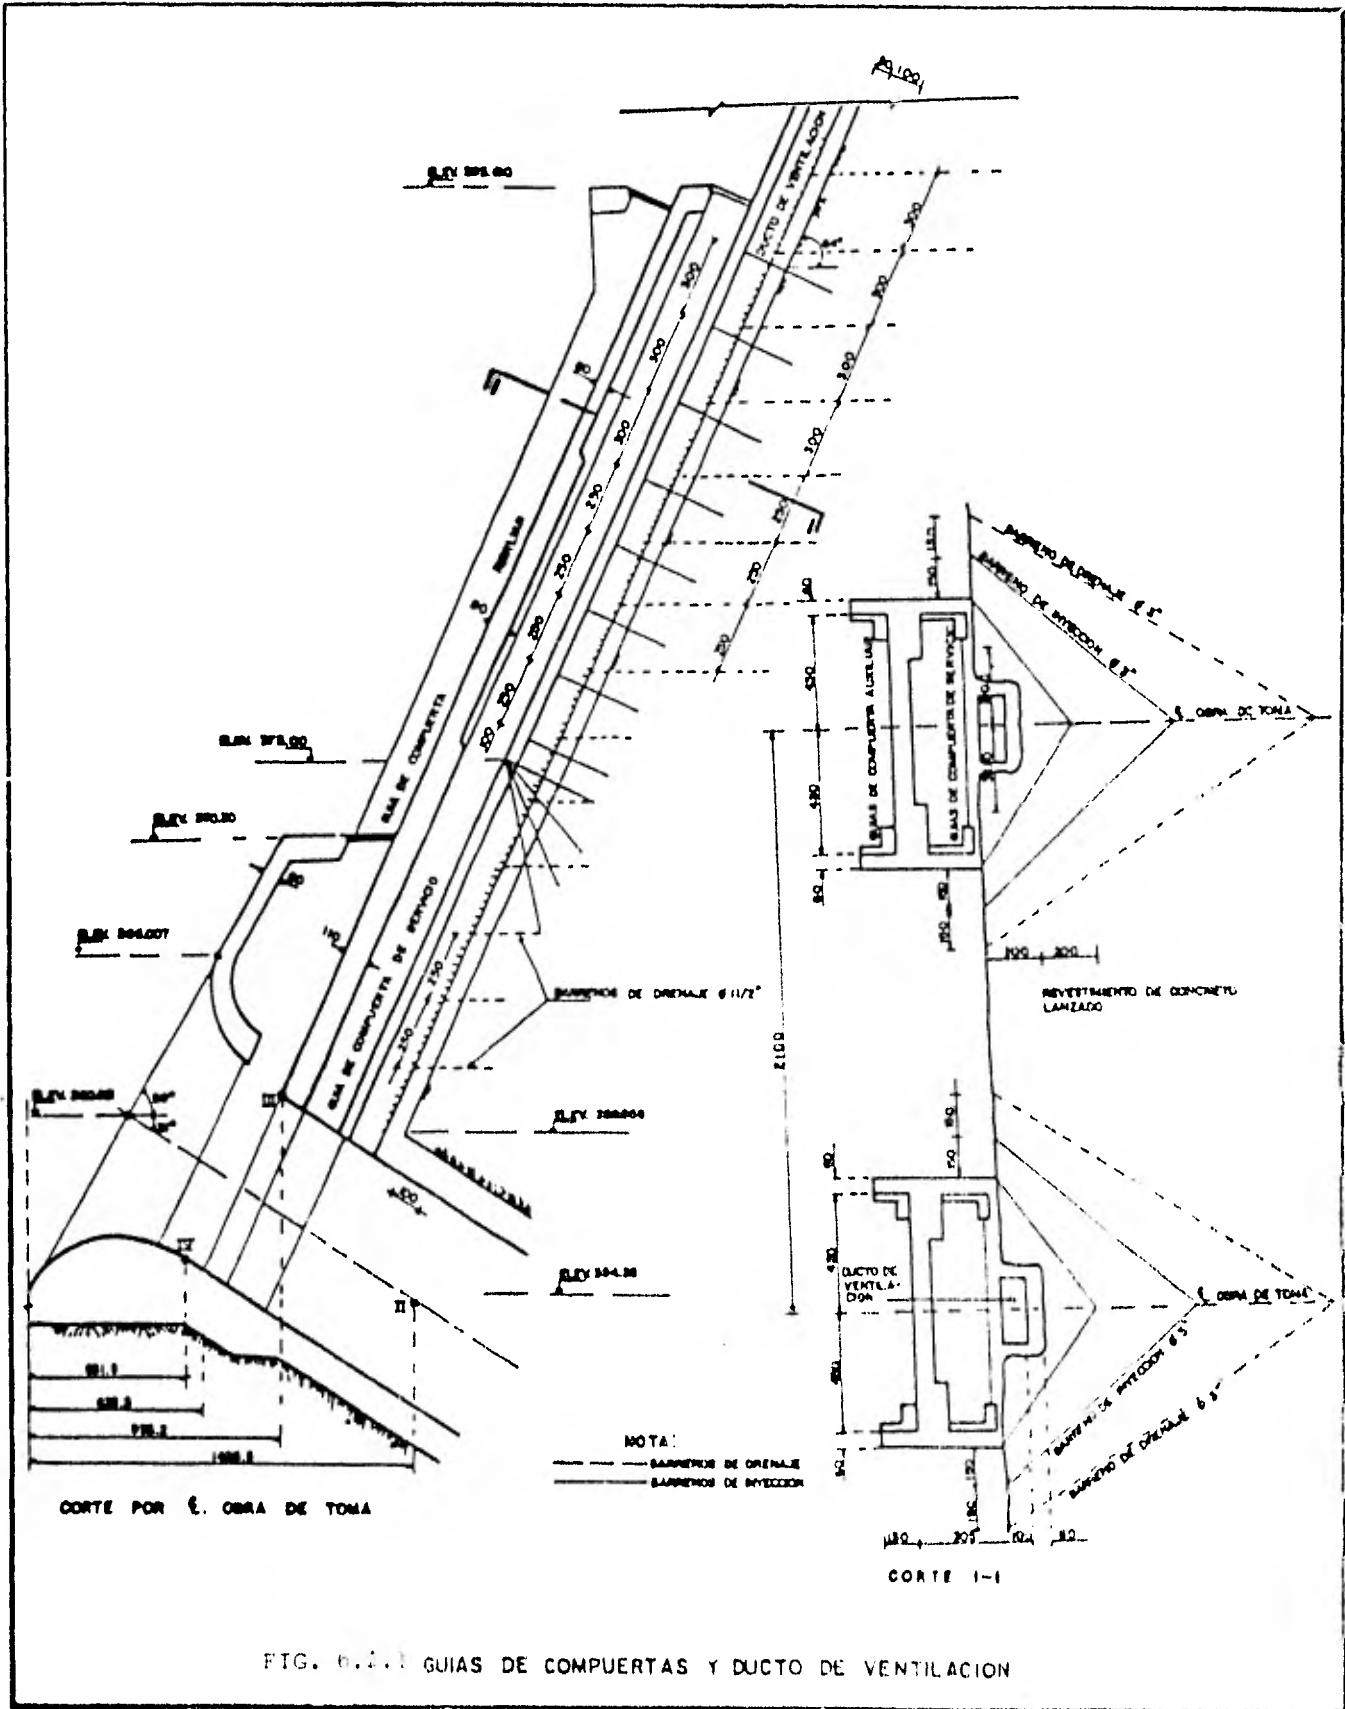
GUIAS DE COMPUERTAS Y DUCTO DE VENTILACION
